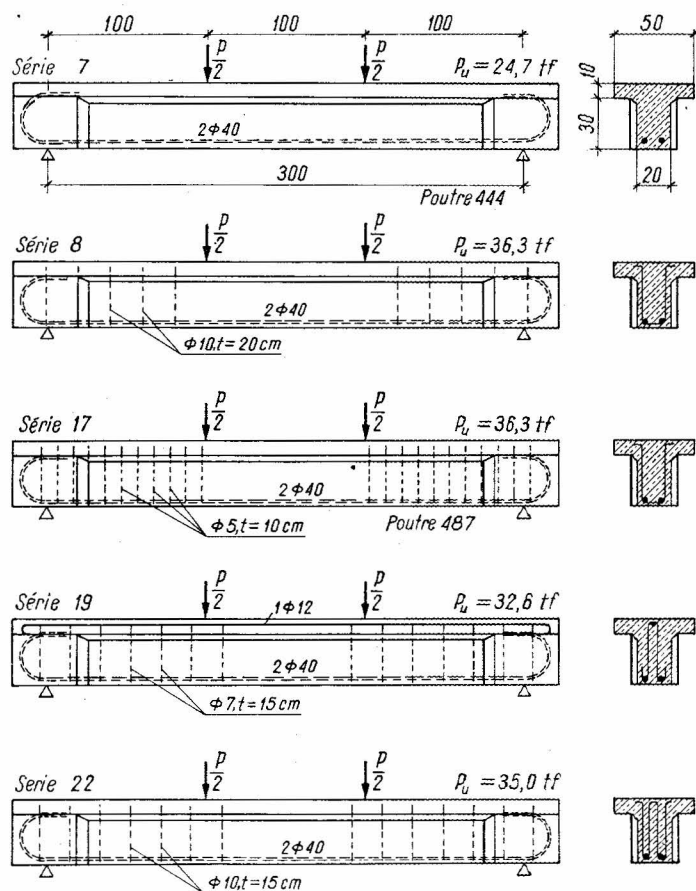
Poutres des essais DAFÉ, cahier 10 [1]
